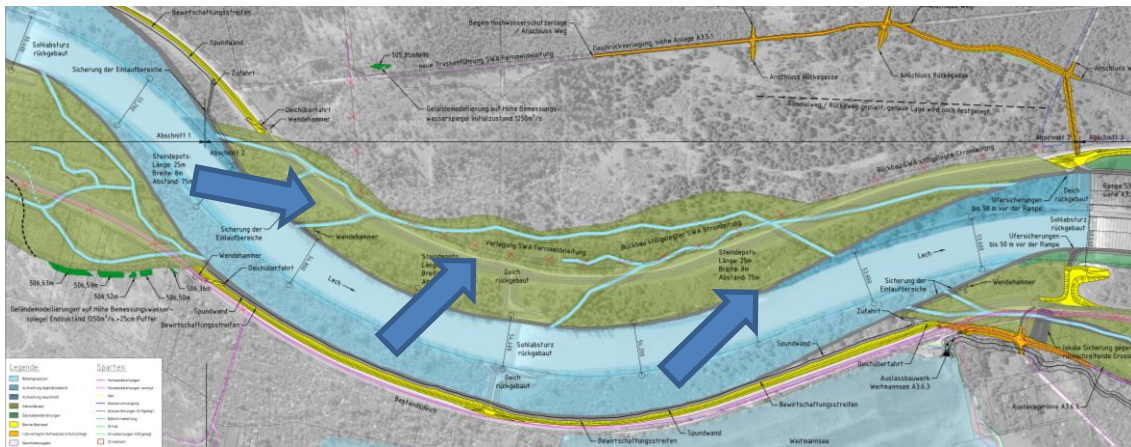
Lageplanausschnitt im Abschnitt 2
